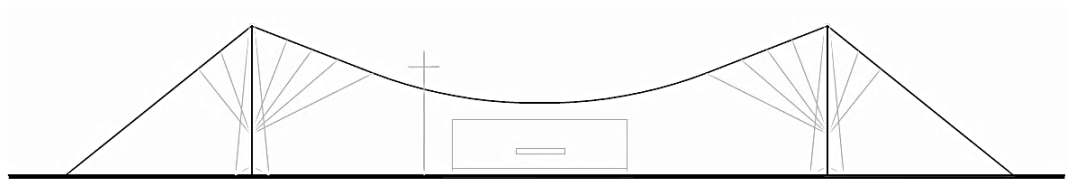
| Cobertura Primeira Missa. 1957. Fachada
